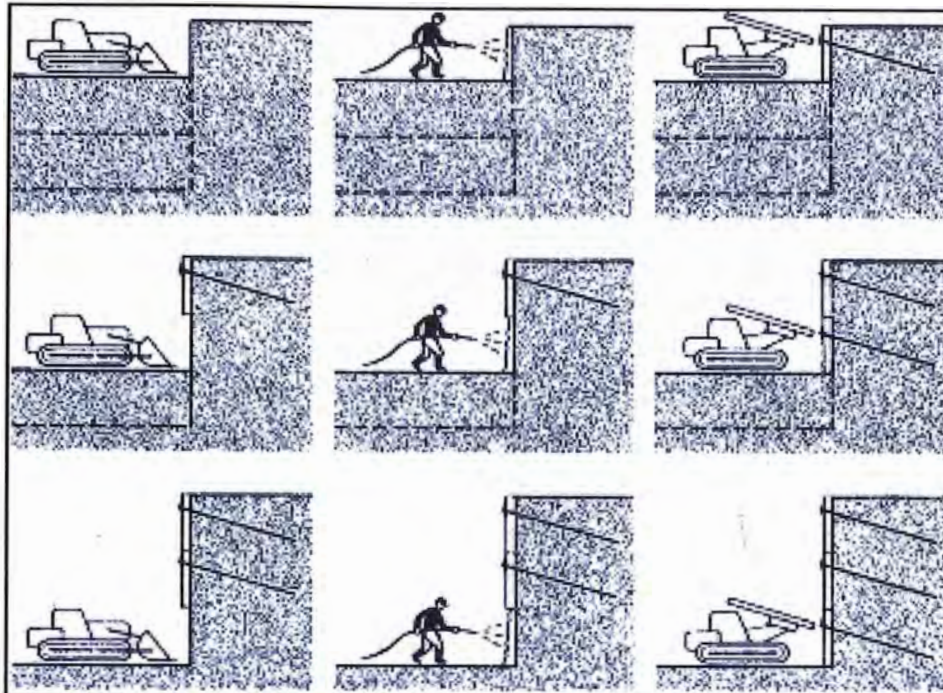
Esquemática sobre el proceso constructivo del Soil Nailing
